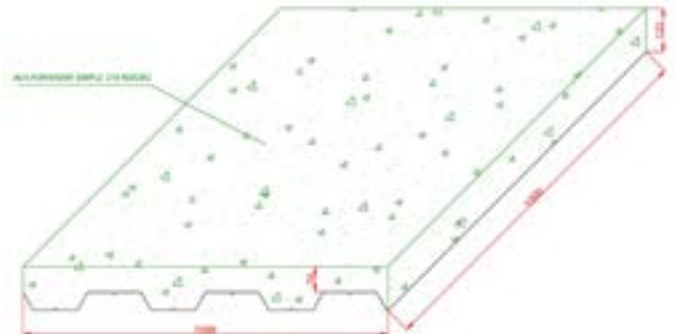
Rubro “Hormigón simple en losa deck 7cm.”
